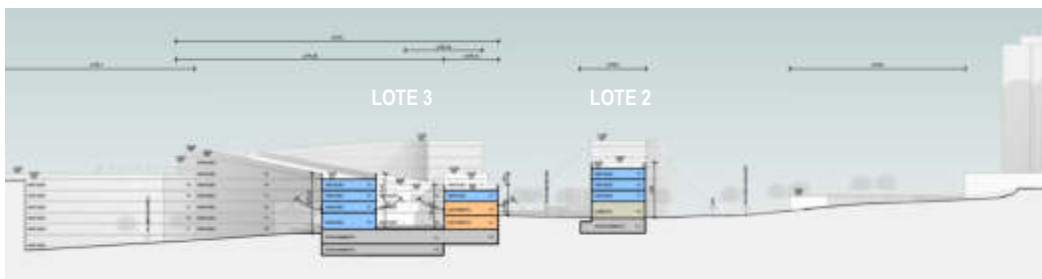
Perfil D da proposta do Loteamento, lote 2 e 3.
